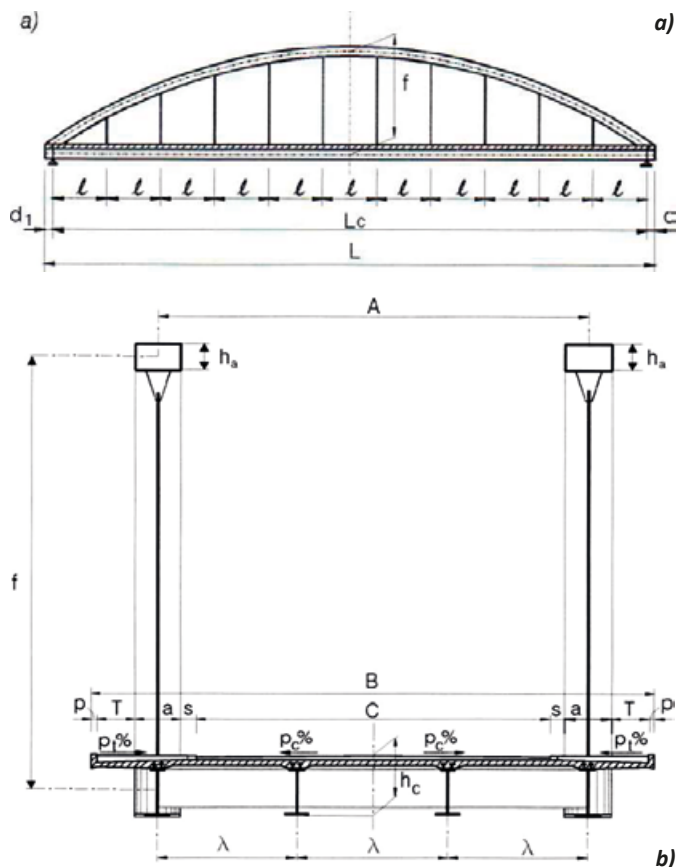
Structură Langer mixtă cu conlucrare: a) Secțiune longitudinală; b) Secțiune transversală
